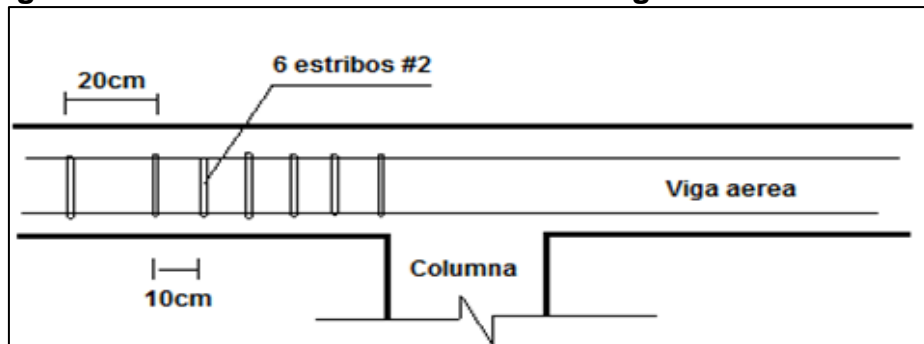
Armada y vaciada de columnas de concreto reforzado
